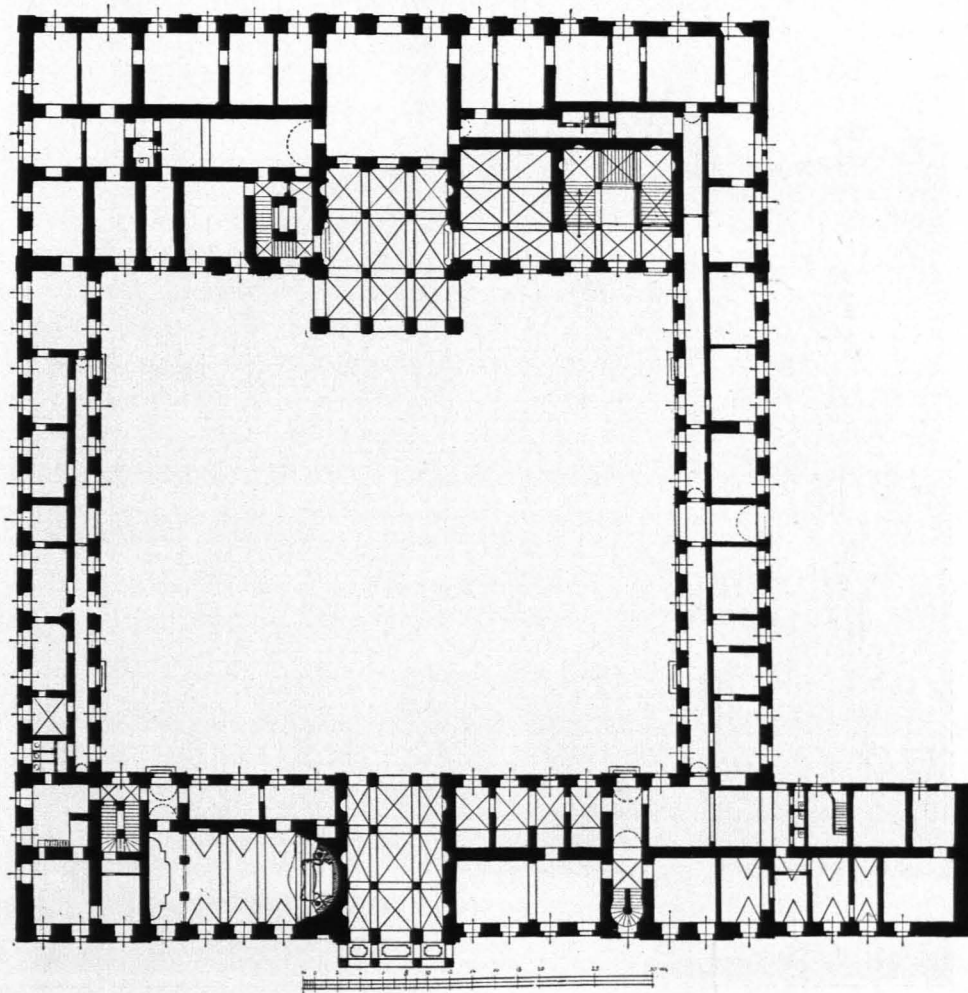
Mirabell, Erdgeschoß, Grundriß 1 : 600 (S. 192)
